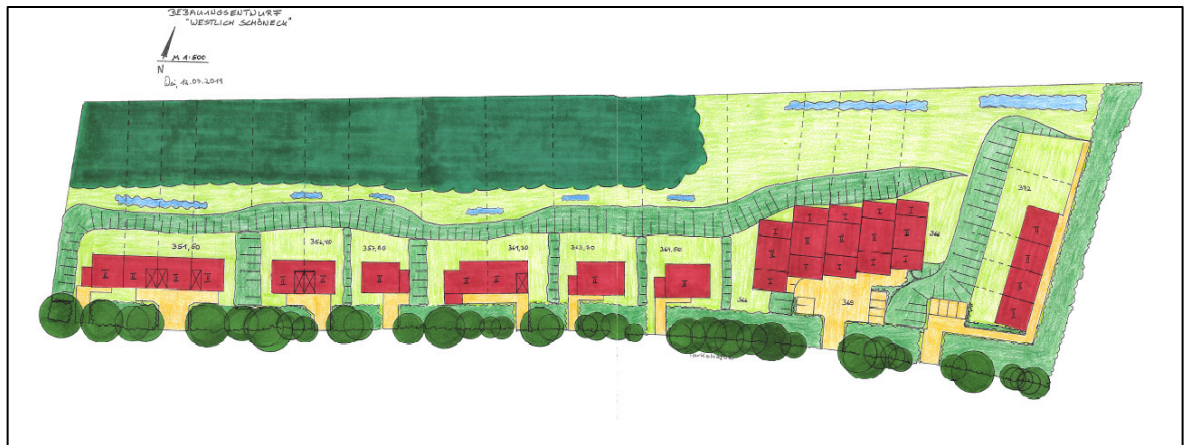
städtebaulicher Entwurf zum Bebauungsplan Nr. 839 "Westlich Schöneck" [1]
